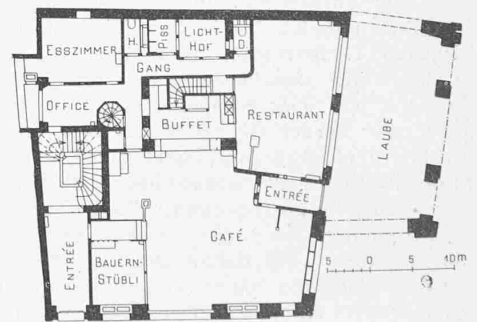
Grundriss vom Erdgeschoss.
